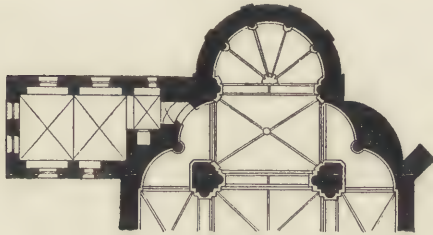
Jetziger Chorgrundriß mit dem neuen Sakristei-Anbau.
